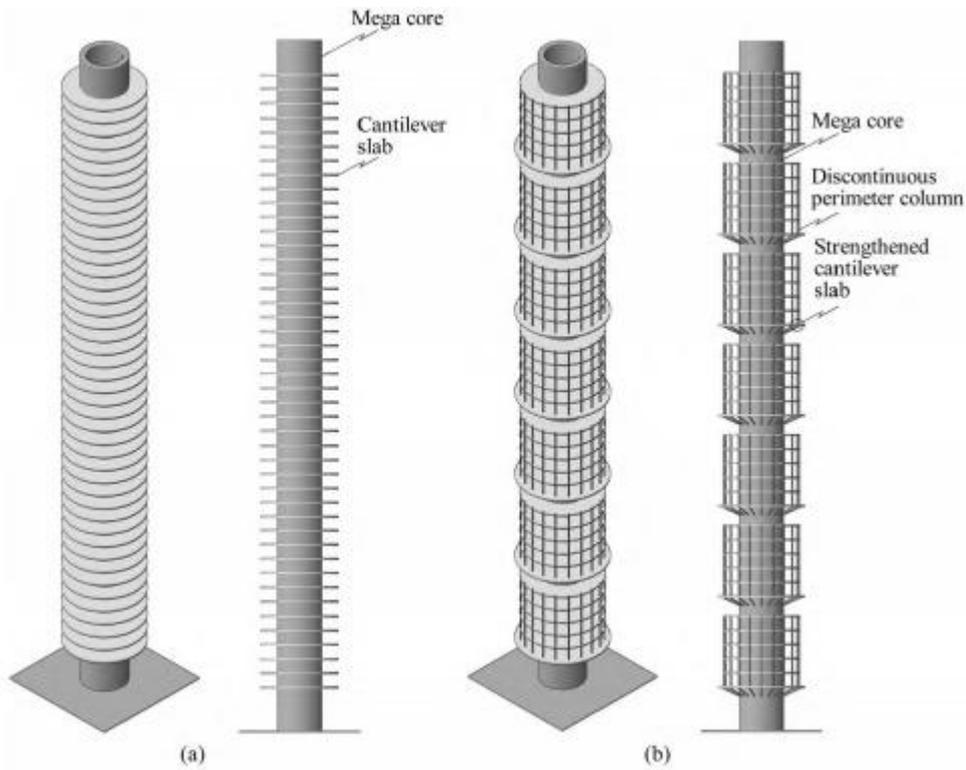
dalles dans les méga noyaux centraux: (a) dalle en porte à faux, (b) dalle en console⁷⁰
